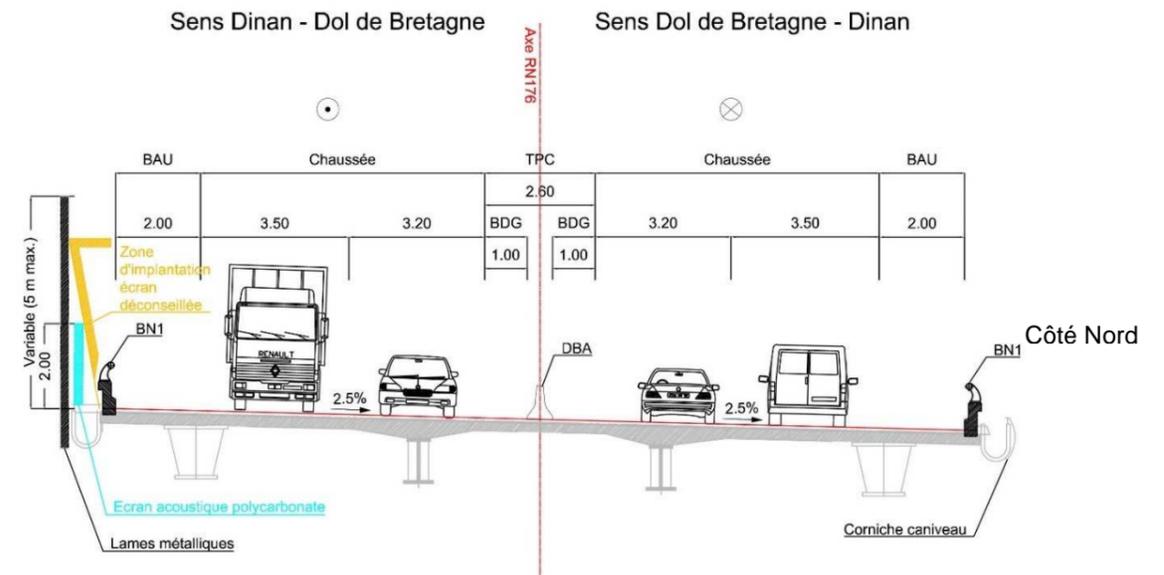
Le profil en travers de la voie et l'implantation réglementaire du mur anti-bruit (source ARCADIS)
